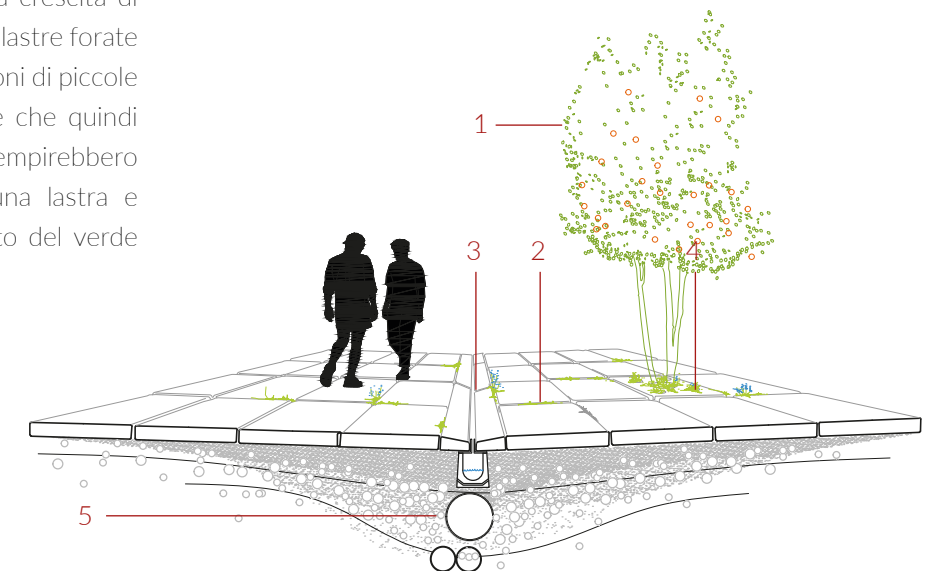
Sezione tipo del rifacimento delle strade all'interno dei sette cortili
